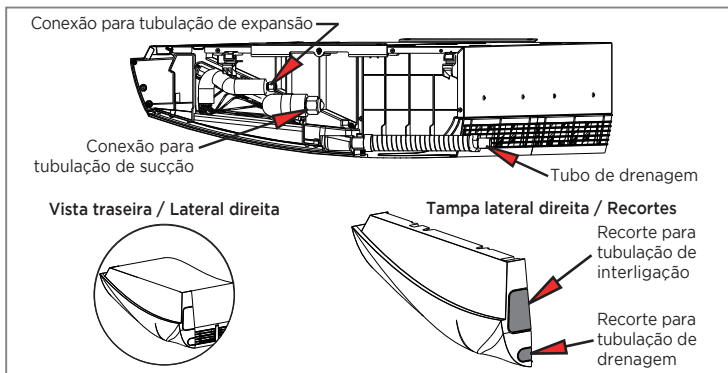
TUBULAÇÕES DE INTERCONEXÃO E DRENAGEM
